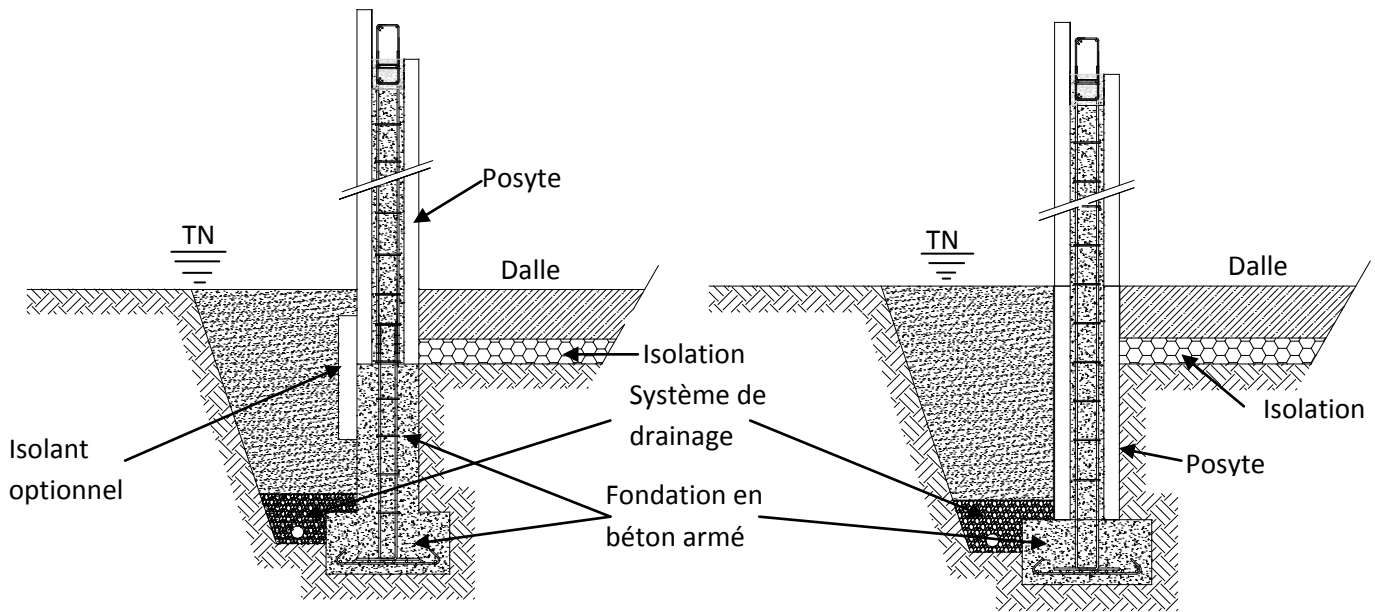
Détail d'une coupe d'un mur en Posytec avec une fondation en béton armé
